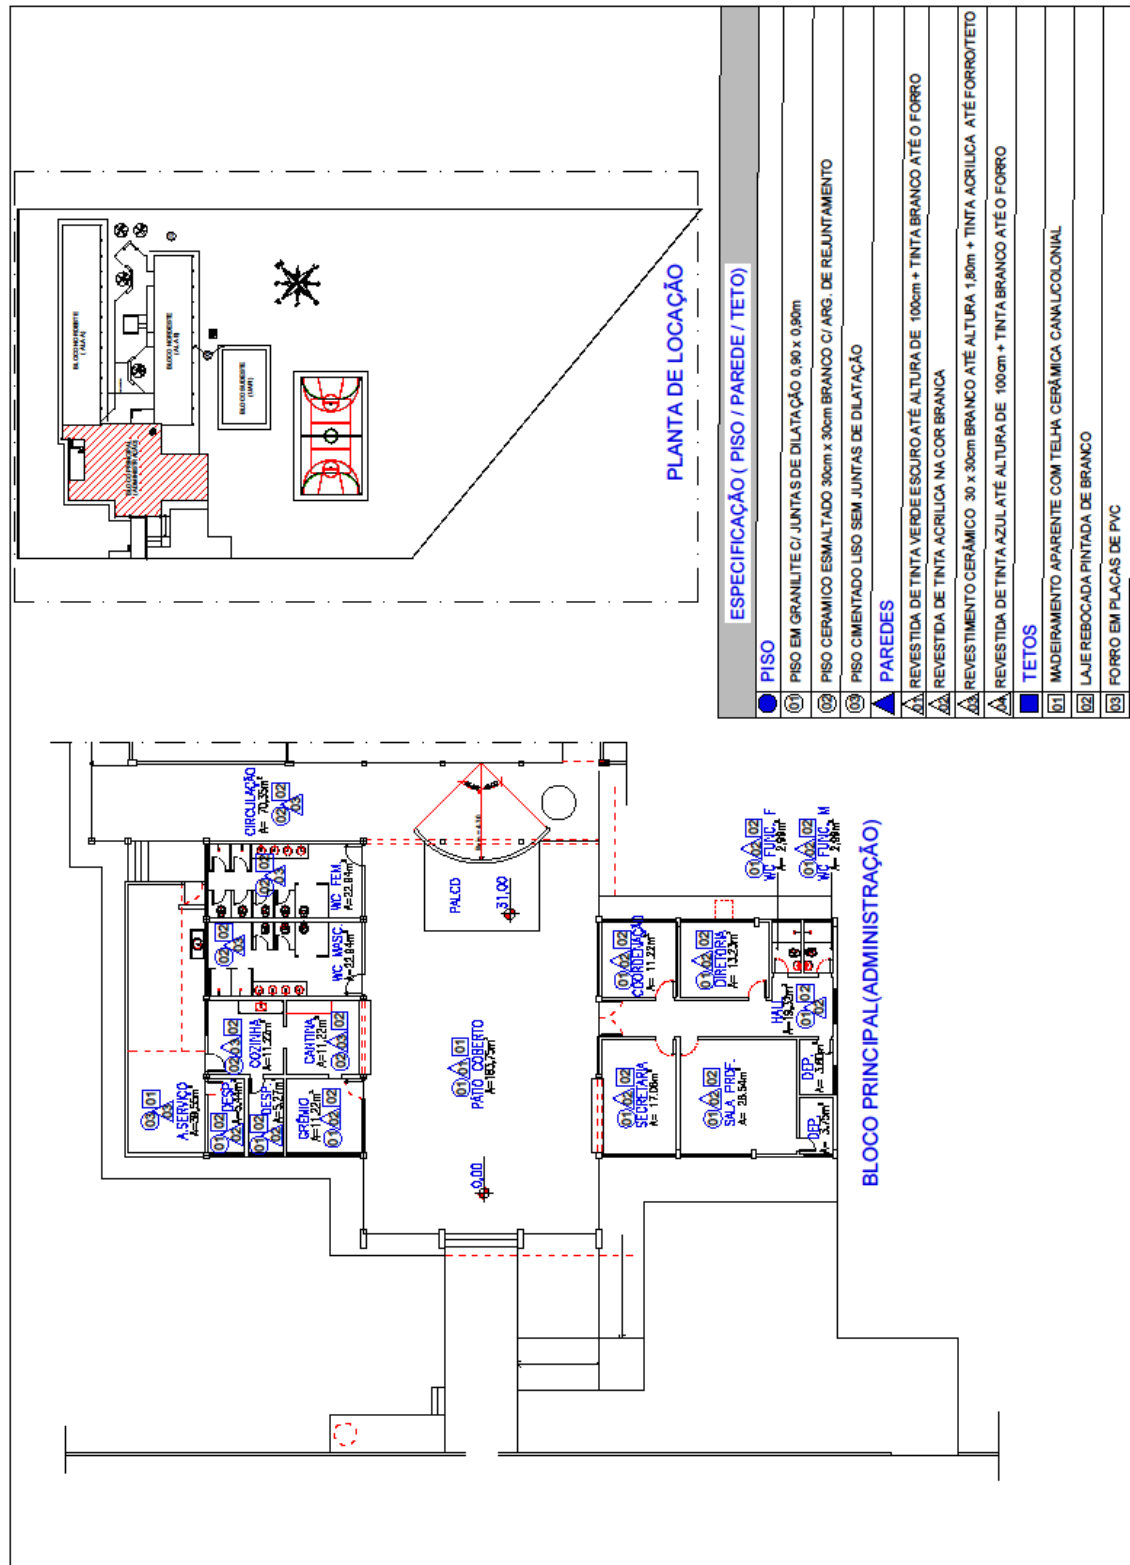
PLANTA BAIXA BLOCO PRINCIPAL
